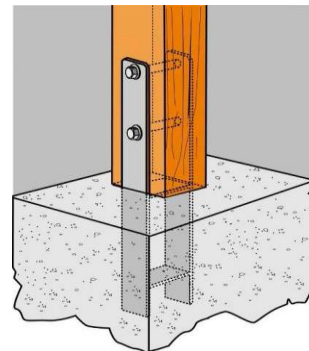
encrage d'un poteau en bois dans une fondation en béton.
